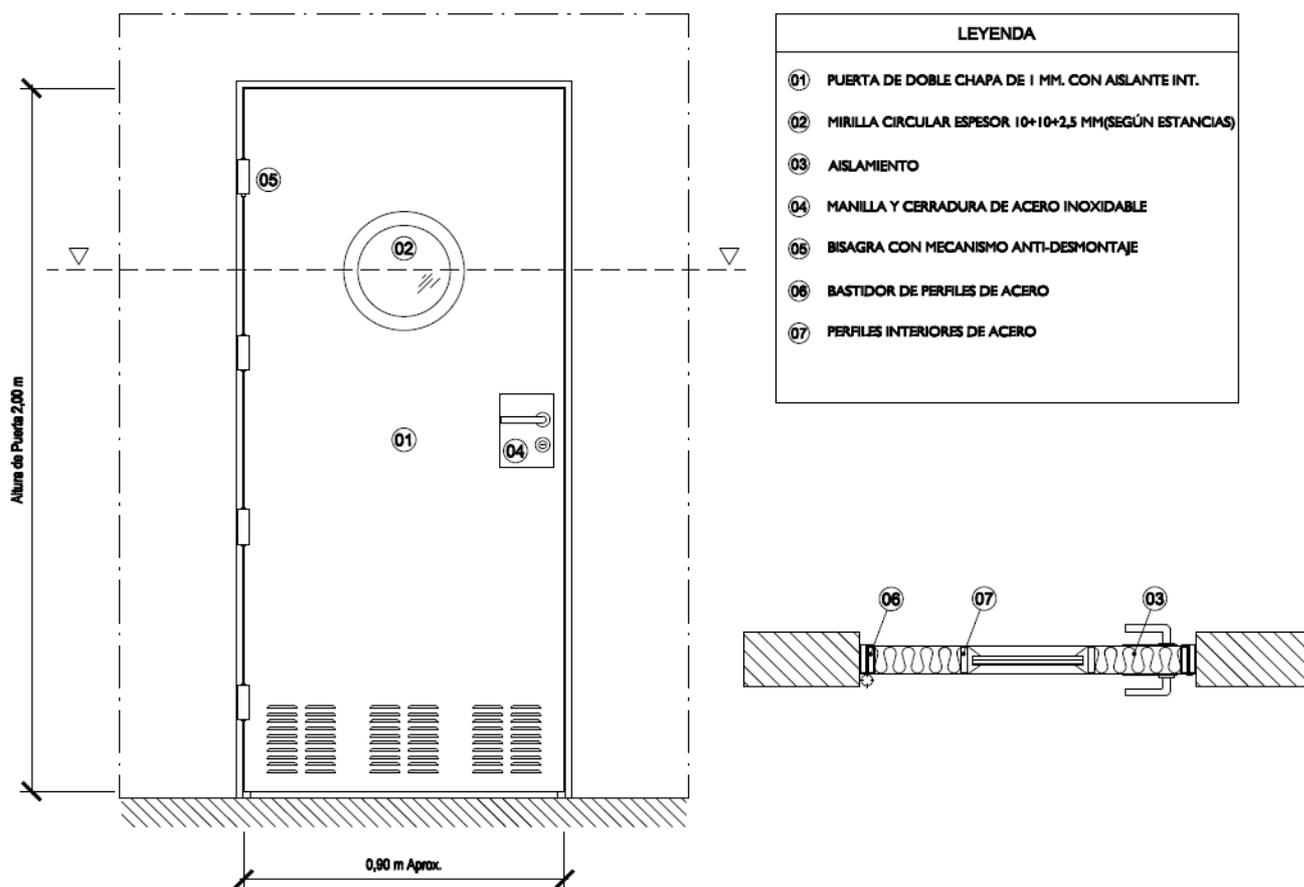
Puerta metálica con mirilla circular y aberturas de ventilación
